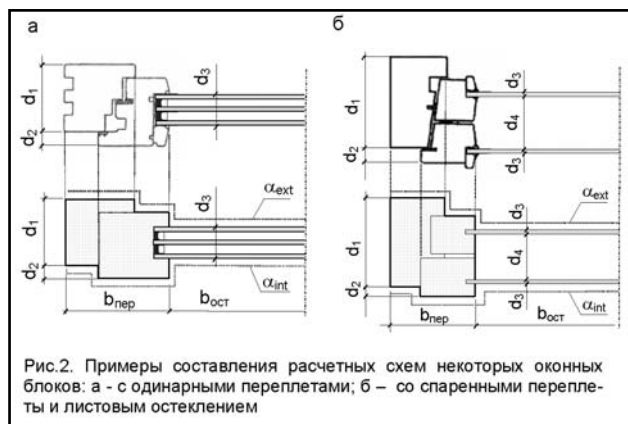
Примеры составления расчетных схем некоторых оконных блоков: а - с одинарными переплетами; б - со спаренными переплетами и листовым остеклением
